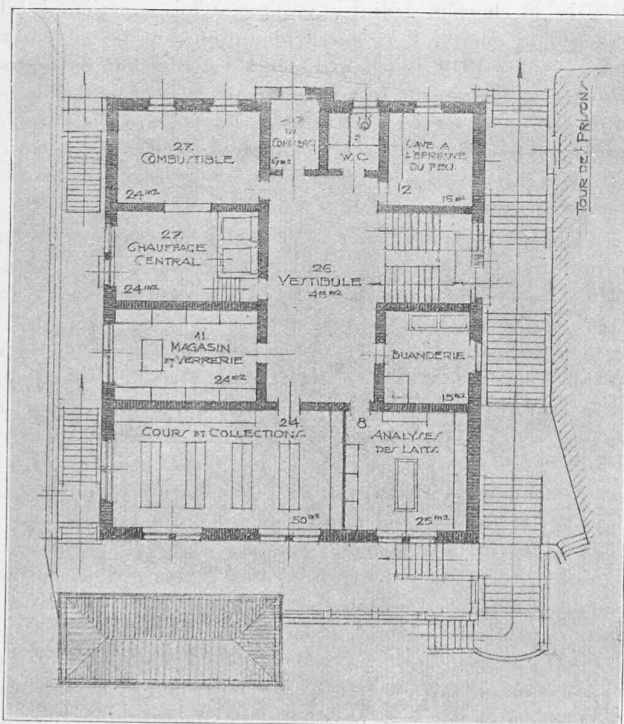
Plan du sous-sol supérieur. — 1 : 300.
